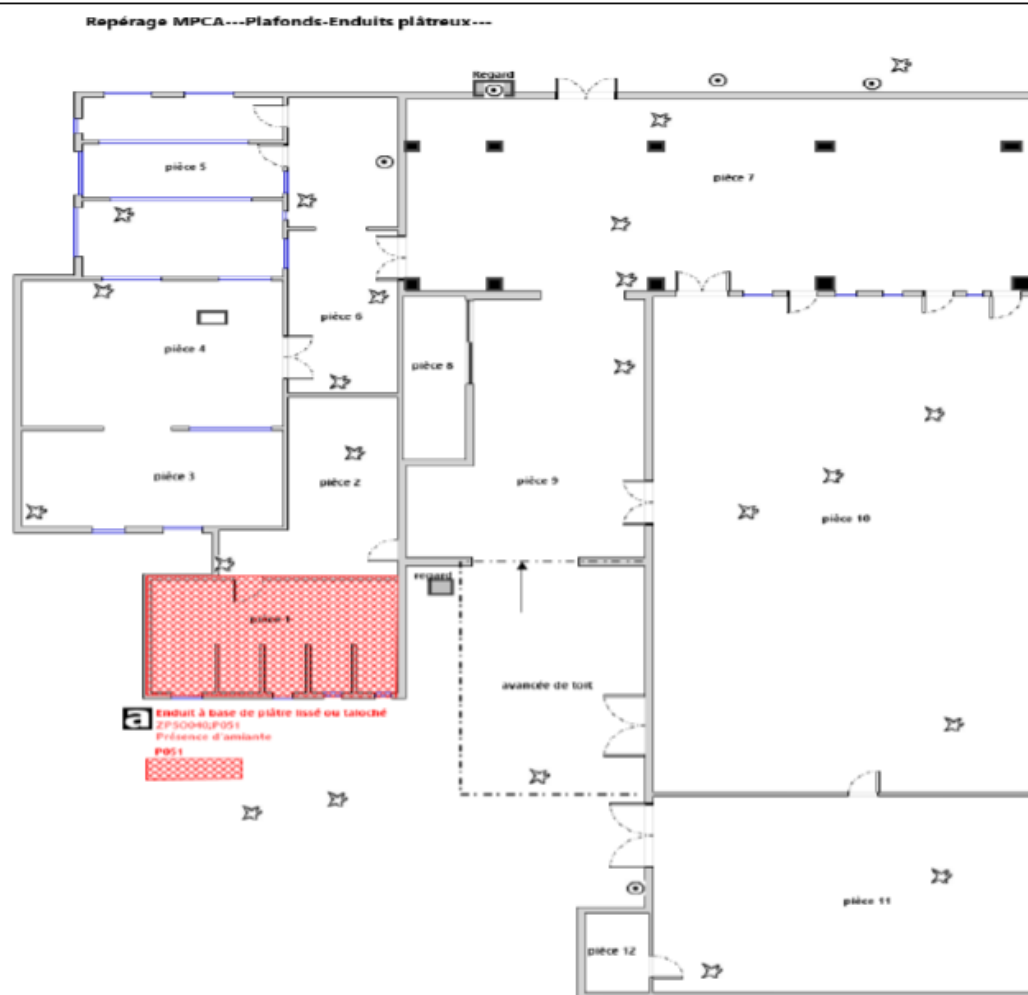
Plan des prélèvements au niveau des plafonds enduit plâtreux contenant de l'amiante dans le bâtiment 3
